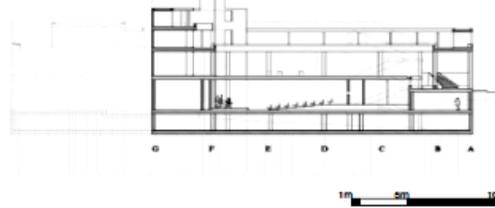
Corte B. Fuente: Los planos del proyecto, son cortesía del archivo de planos de Rogelio Saloma del museo de arquitectura
